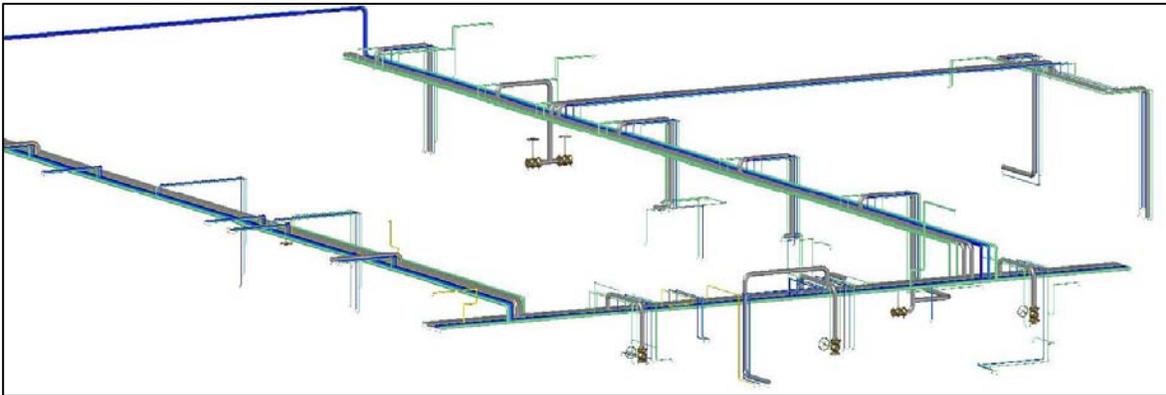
Modelo 3D de Tuberías en Planta Piloto FES Zaragoza (Vista 5).
